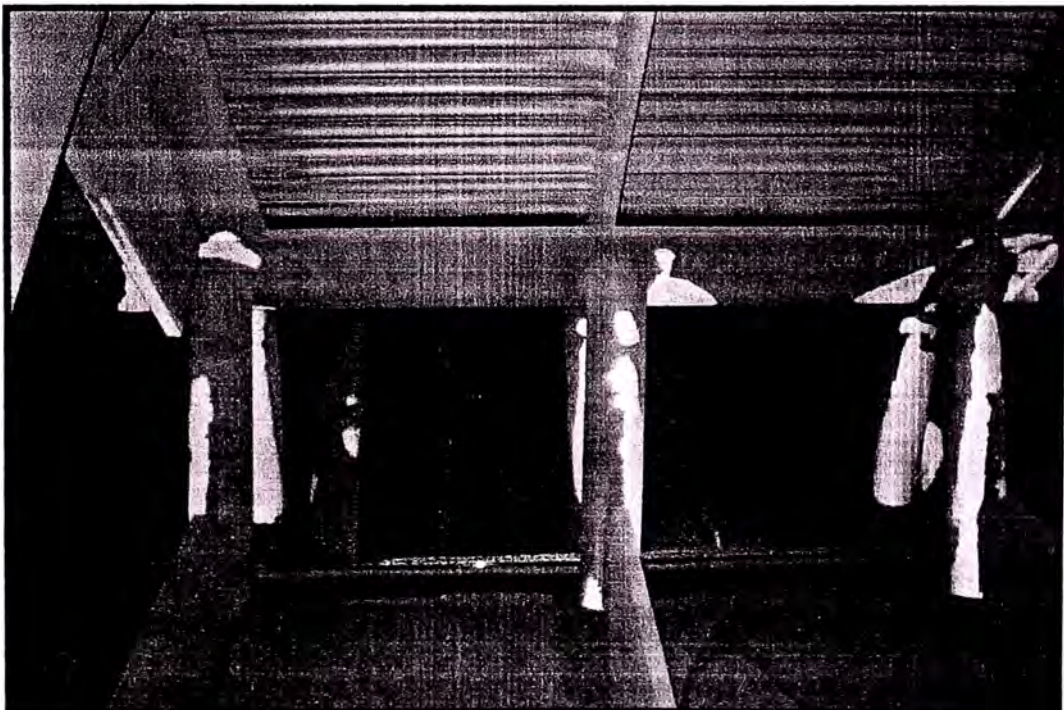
Vista sección de baja presión TV N° 05
